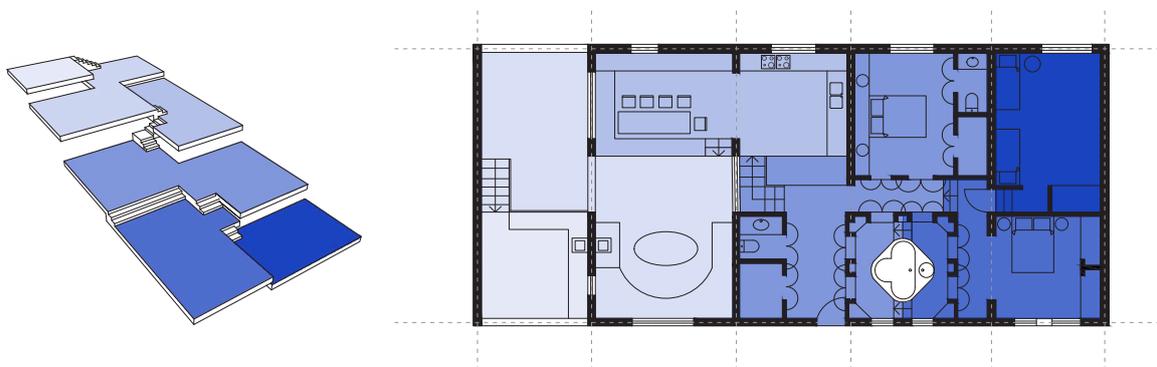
Perspective du jeu de niveaux et plan d'un T6
